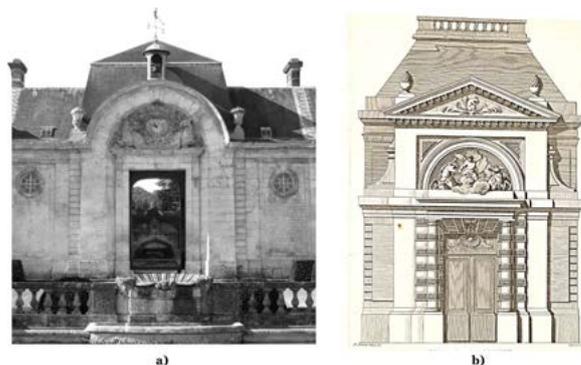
Pierre Contant d'Ivry; a) Puerta interior Court Écurie del Château Bizy; b) *Les Oeuvres d'architecture* (1769), lámina 47.
